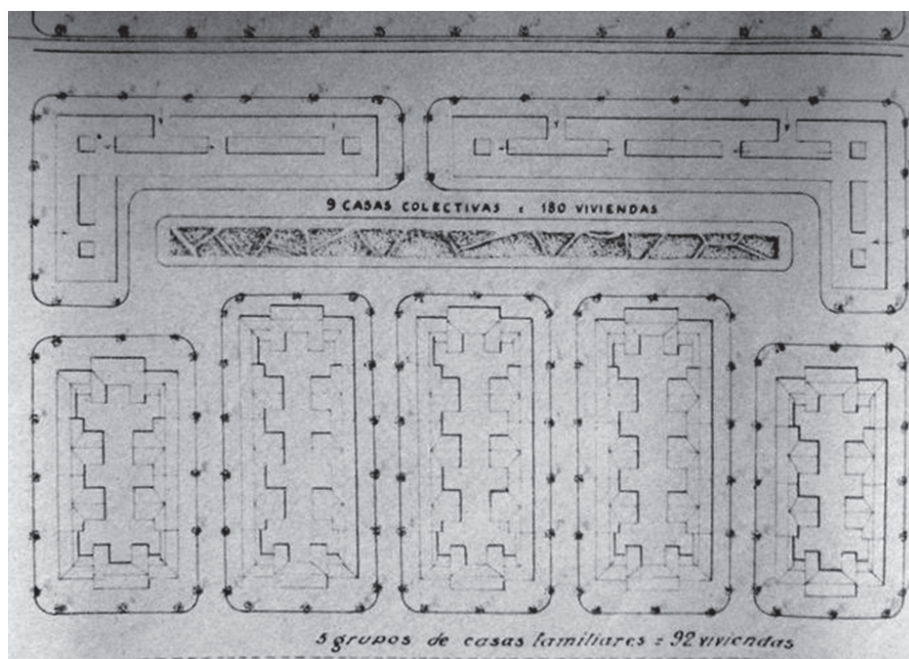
Planta de ordenación de la zona de Paseo al Mar. Concurso de iniciativas para la construcción de viviendas modestas en Valencia (1930). Propuesta de Fomento de Construcciones y Contratas S.A.
